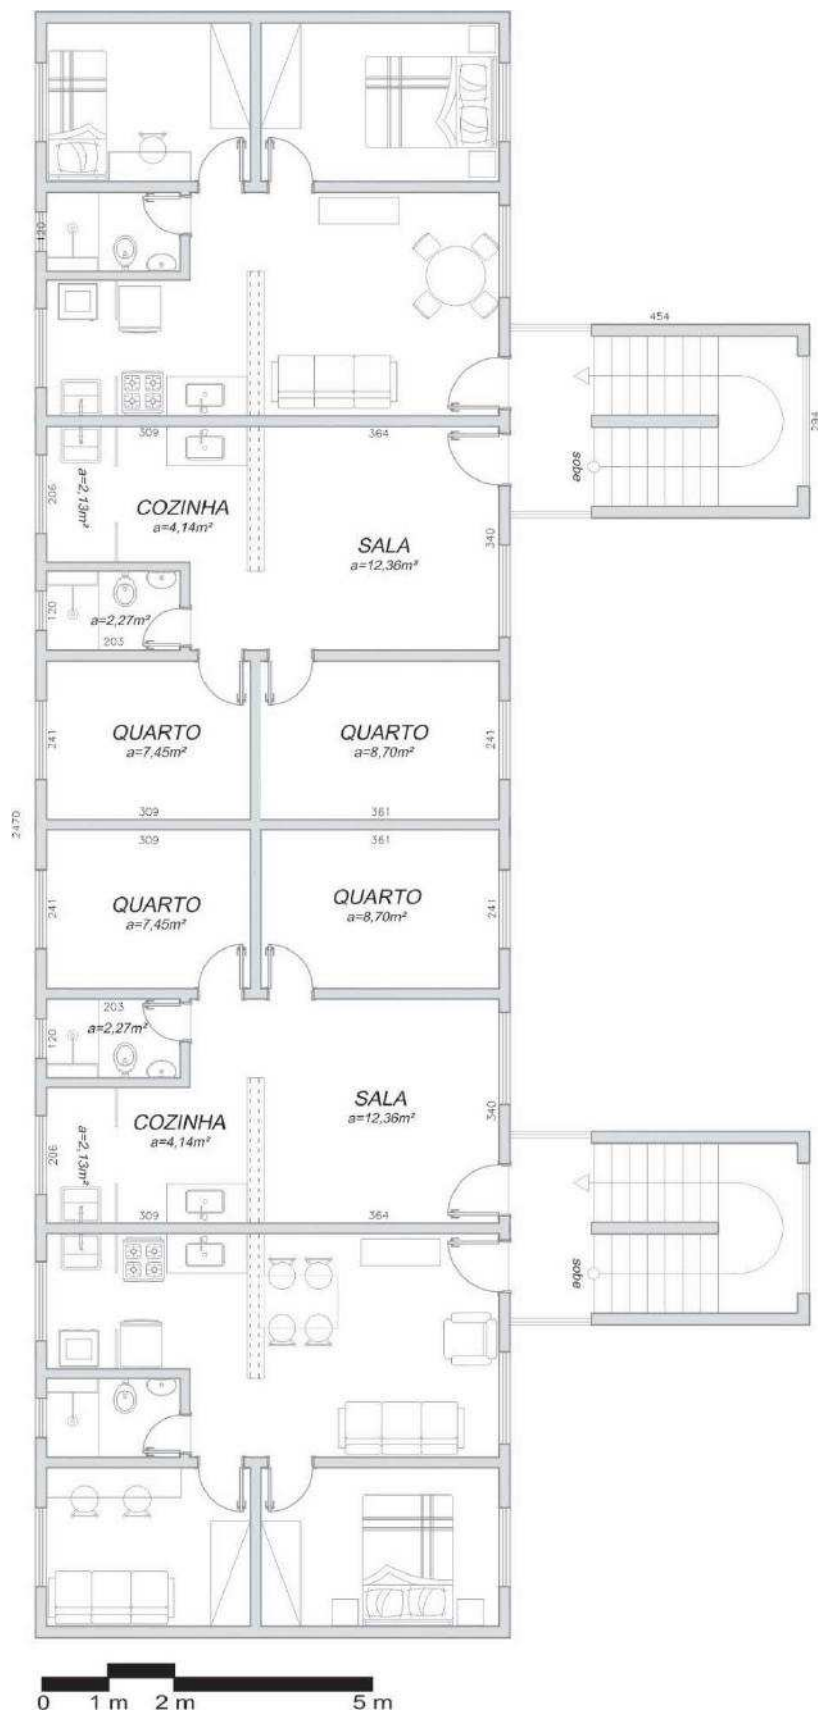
Planta do pavimento tipo (com propostas de layout) com quatro apartamentos do Residencial Aroeira.
